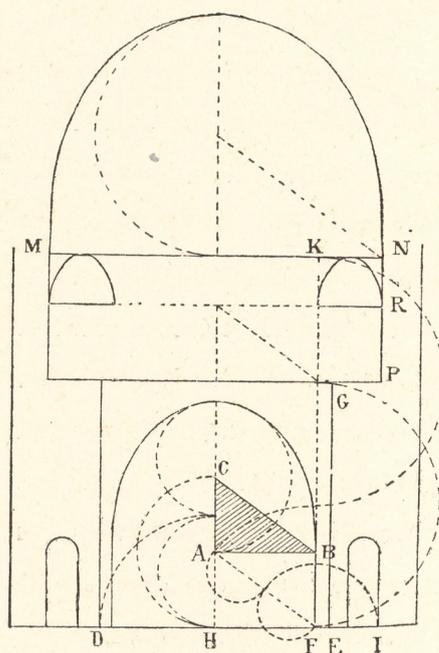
Coupe transversale de la salle C, pl. III (Épure de construction).
